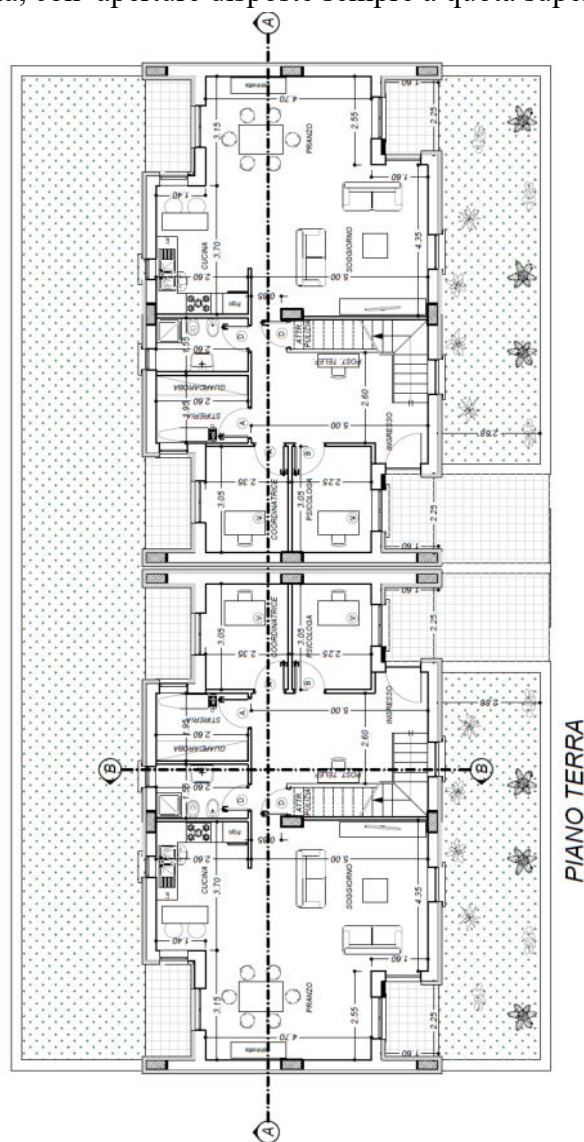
Planimetria del piano terra dell'edificio di progetto con indicazione delle tracce di sezione A-A e B-B
